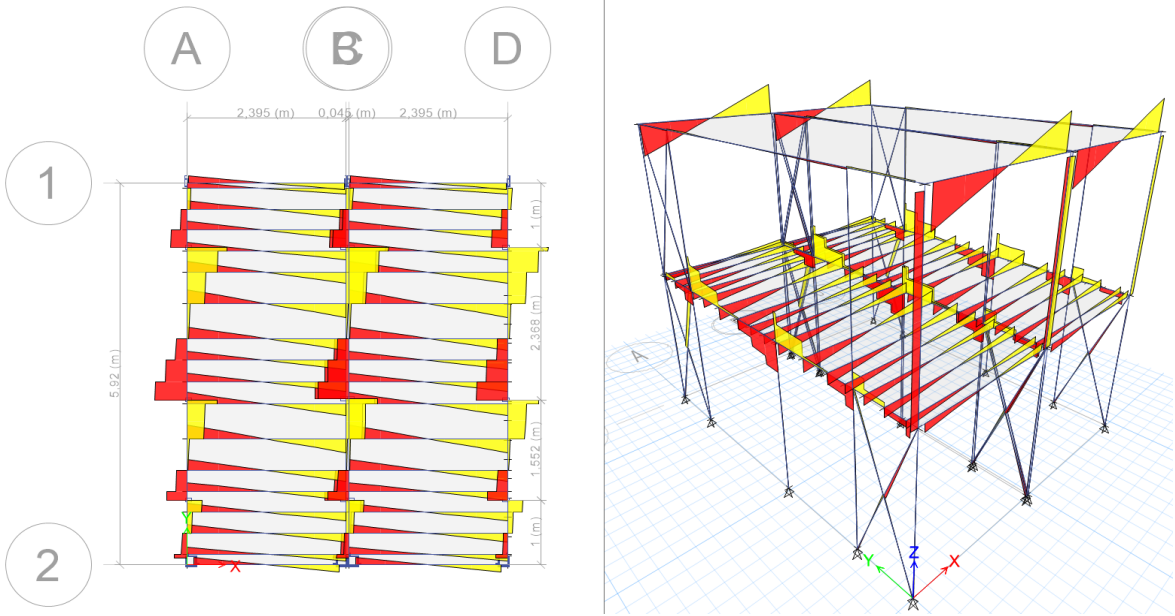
Diagrama de corte. Vista en planta y perspectiva
